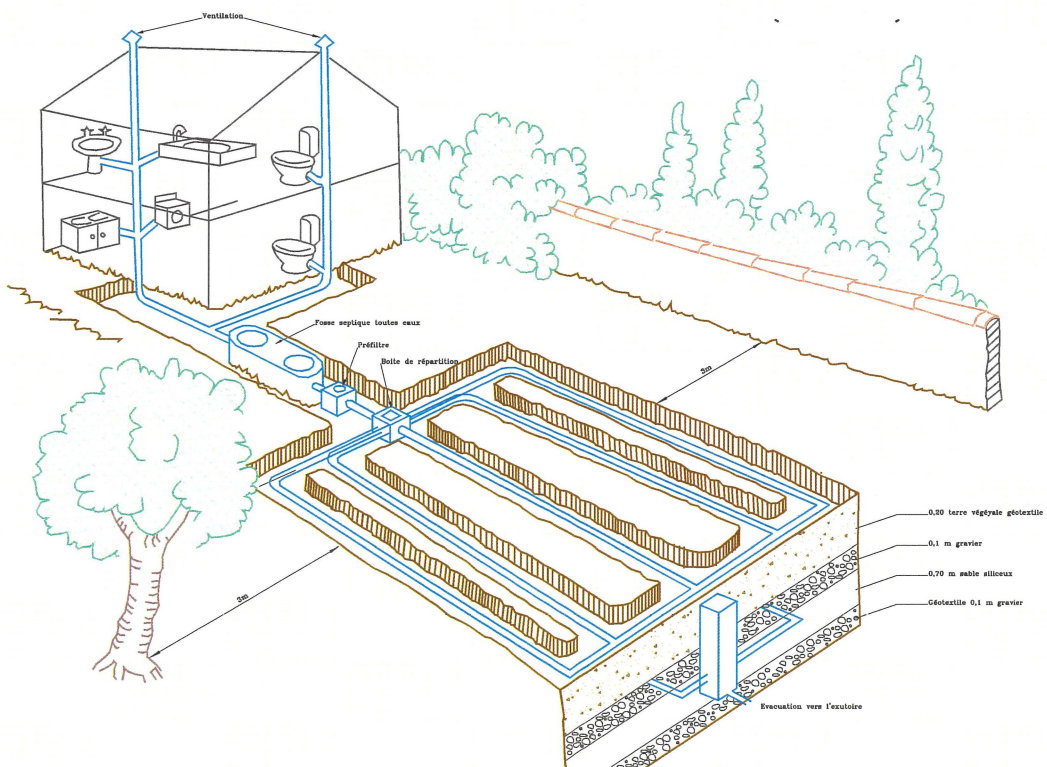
Exemple d'une filière d'assainissement non collectif avec filtre vertical drainé
